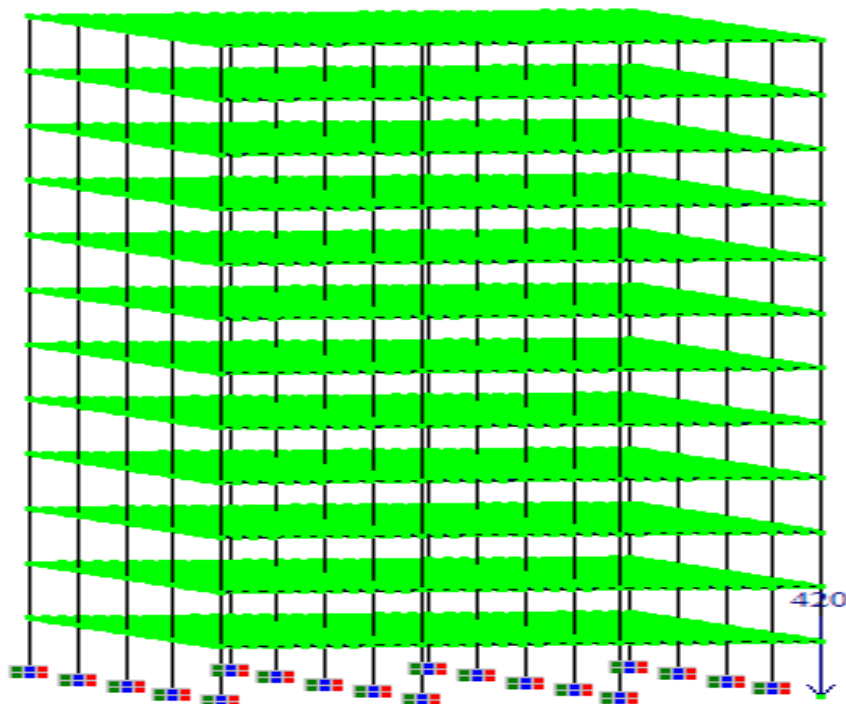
Schéma illustratif du modèle d'étude du bâtiment avec planchers sans hourdis à 12 niveaux avec un chargement vertical sur le poteau d'angle
